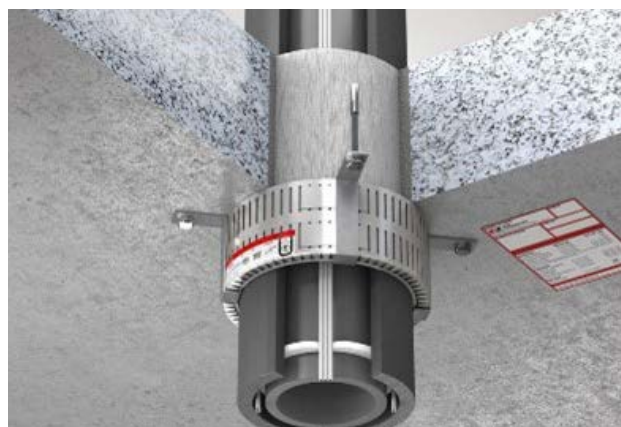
Brandschutzmanschette eingebaut in einer Decke
